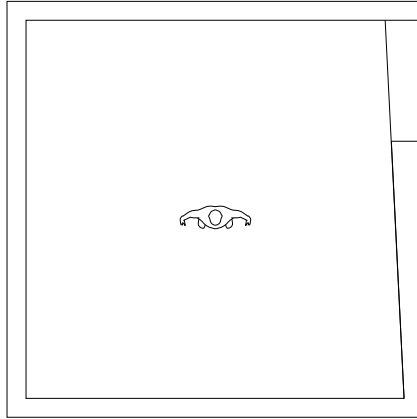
Pos. V.II* | *Grundriss – M.1:100
